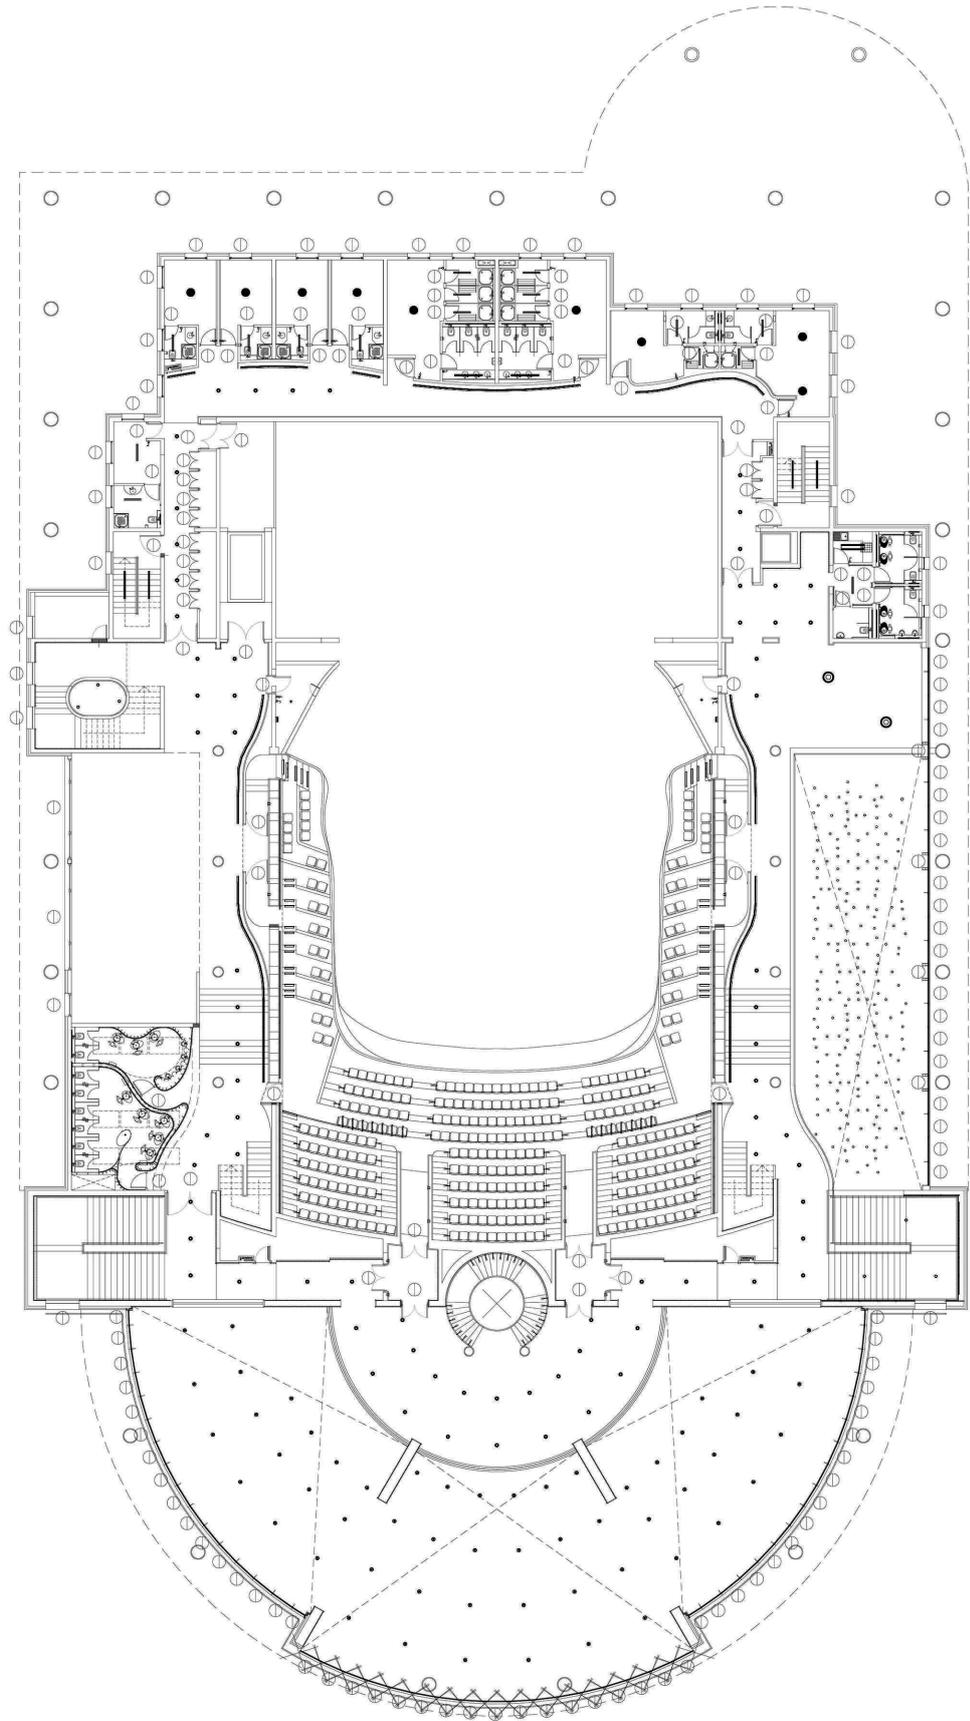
Planimetría del primer piso del Teatro del Lago. (Yávar, 2012).
